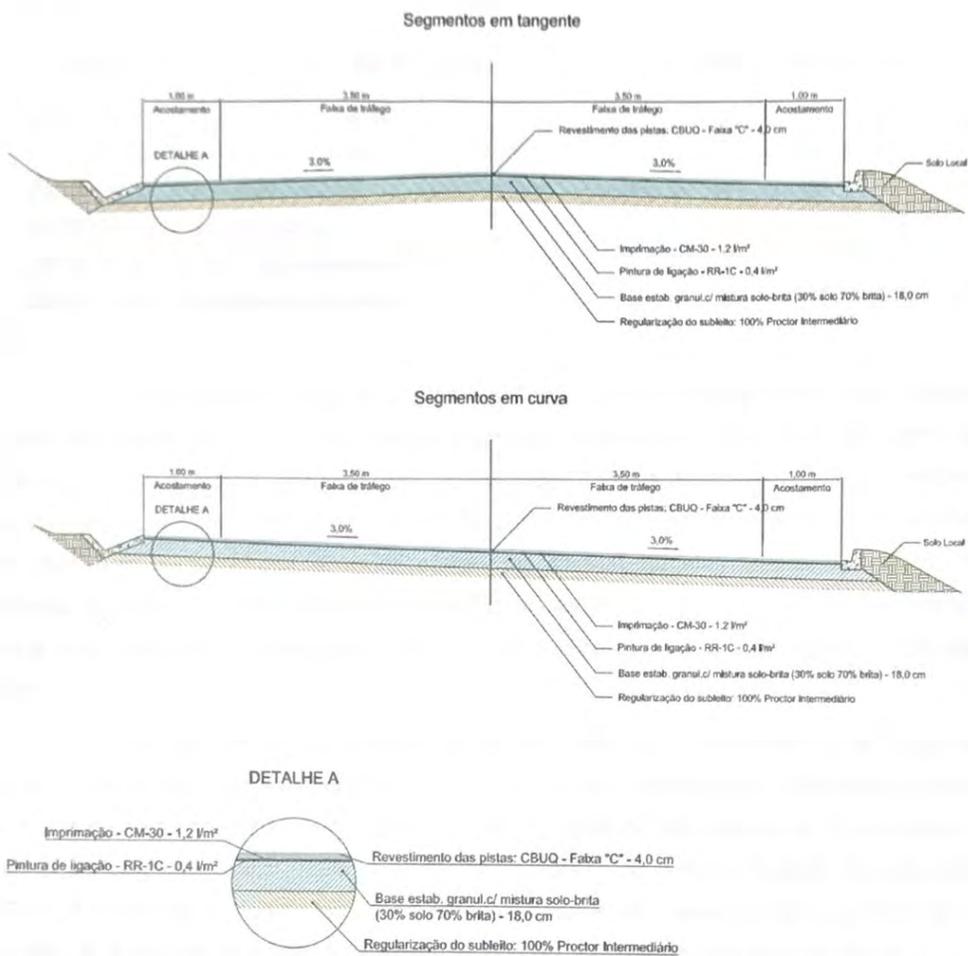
Seção transversal típica – Pavimentação asfáltica MS-473.
